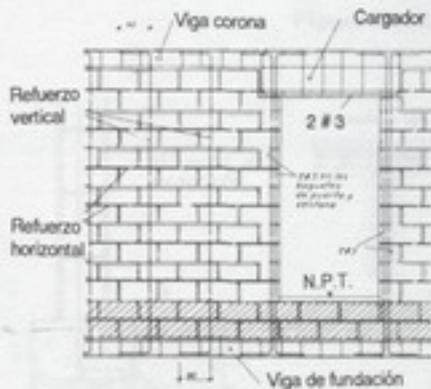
Elevación típica de pared mampostería con refuerzo integral.
